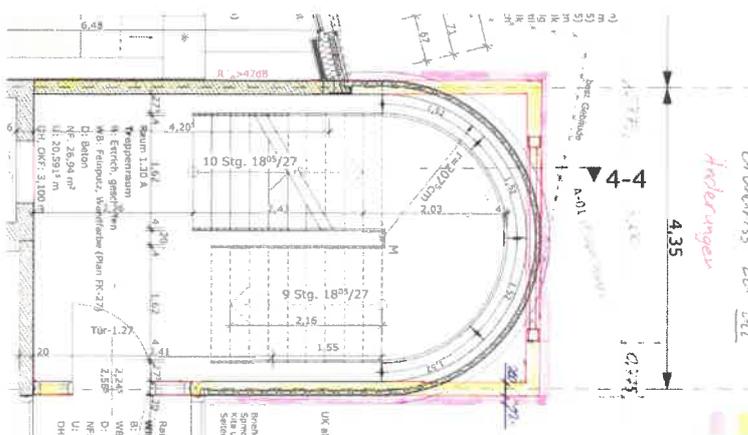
Skizze Grundriss Treppenhaus mit Angaben zur geplanten Änderung
